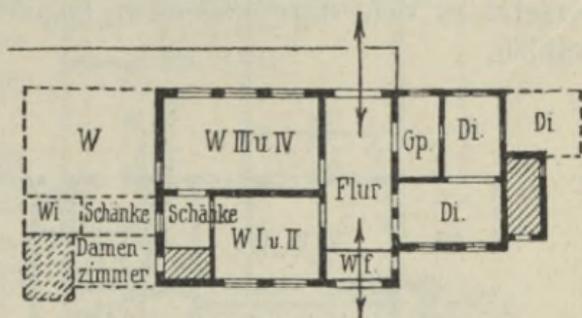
5. Grundrißmuster von Empfangsgebäuden für mittlere Stationen.
